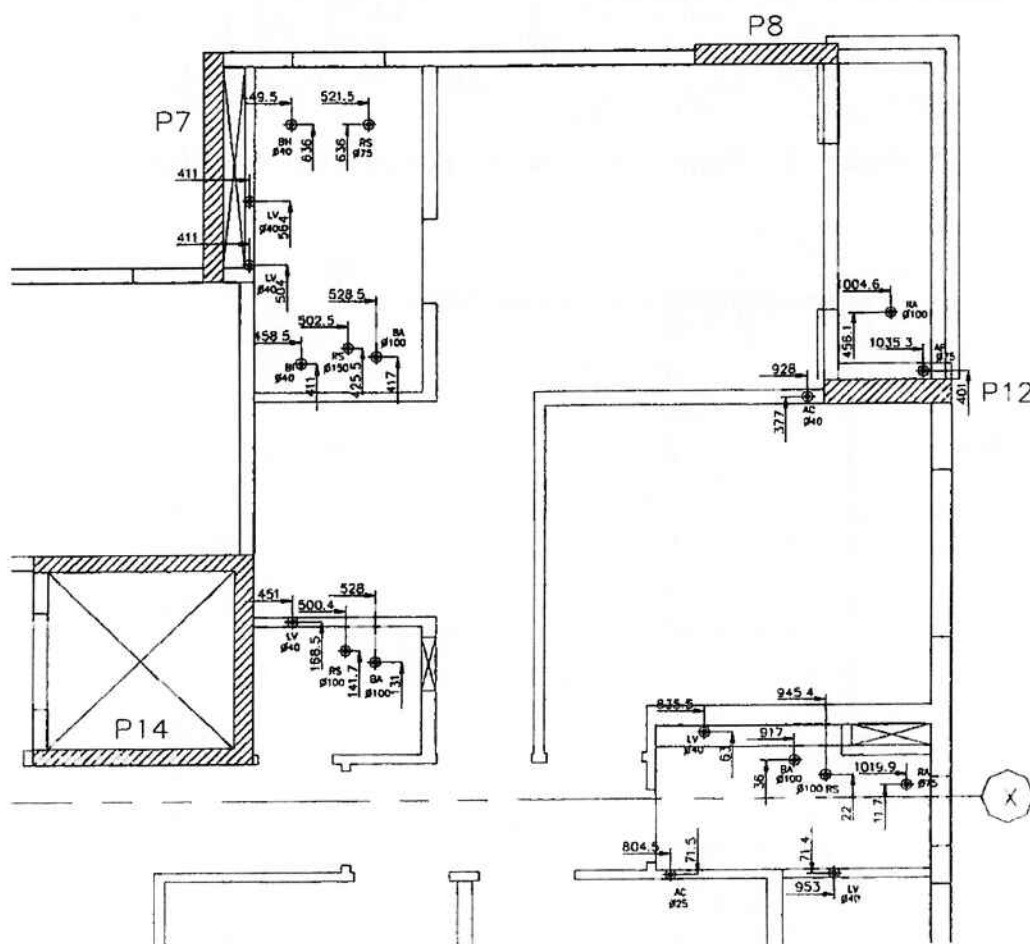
Planta de locação dos pontos hidráulicos na laje
